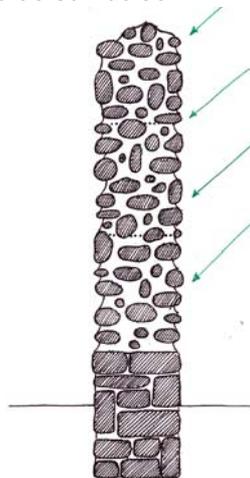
Lavado superficial de un muro de tapia de hormigón.
